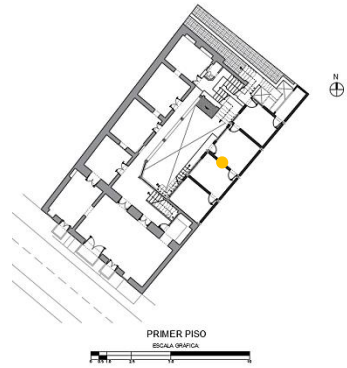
Afectación estructural Bloque 02 • Fuente: Ilustración Propia
